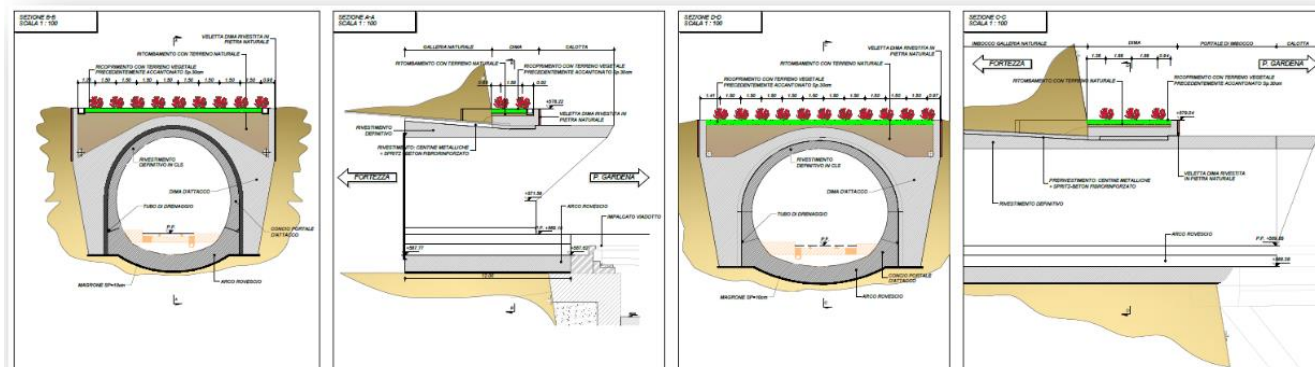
Opere a verde – Sezioni di progetto imbocco Galleria Scaleres – Imbocco Sud.
